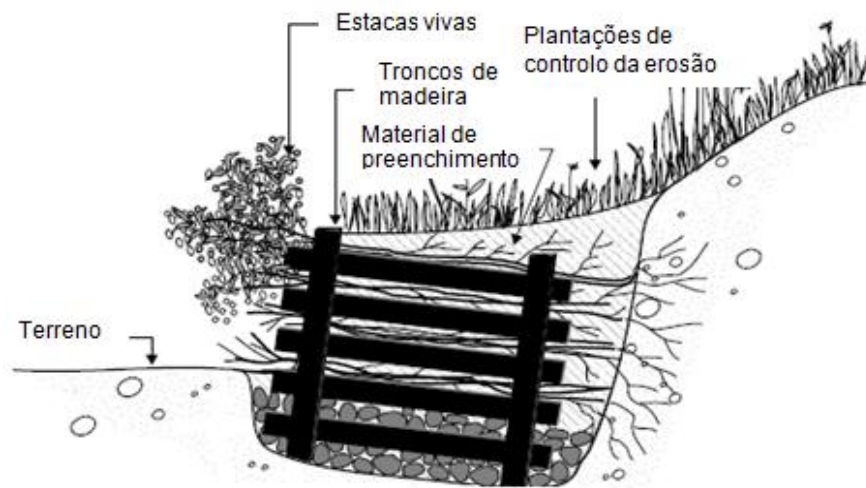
Aspeto construtivo de um muro de madeira tipo cribwall em seção transversal (adaptado de Sotir & Grey, 1992)
